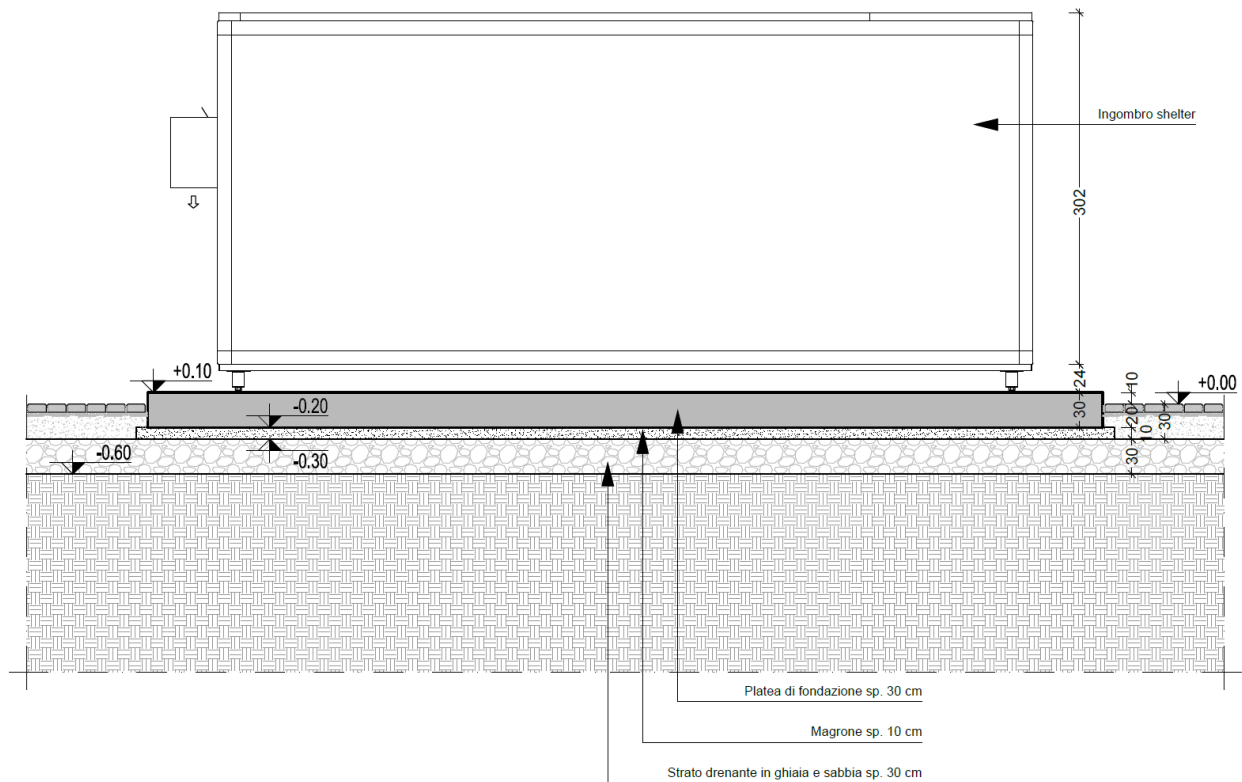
Sezione tipo basamento fondazione e Shelter per PPT
